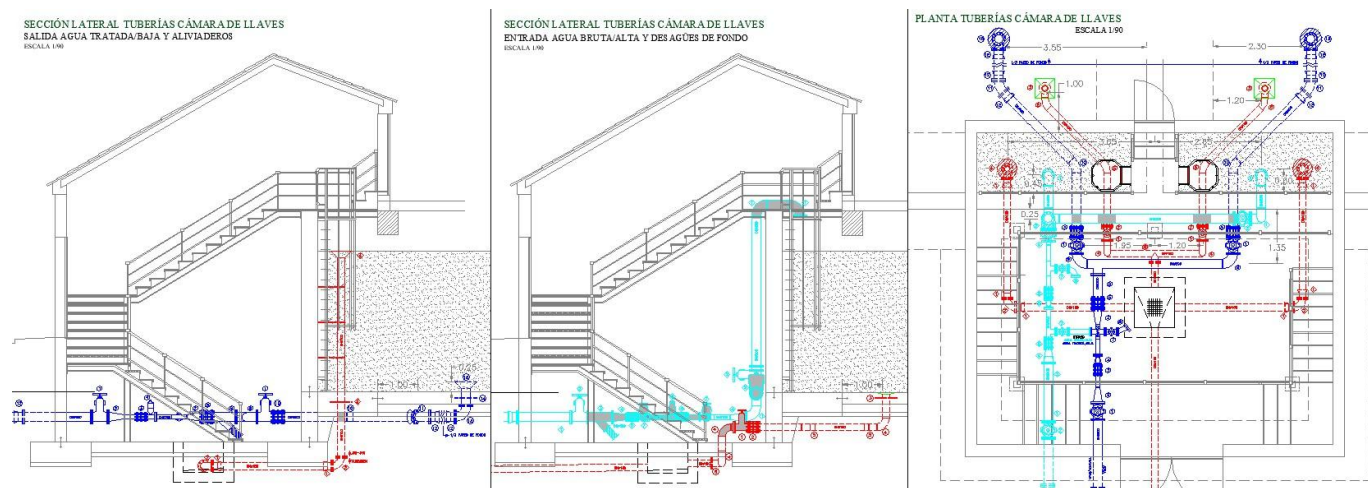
Planta y alzado tipo para la cámara de llaves.
